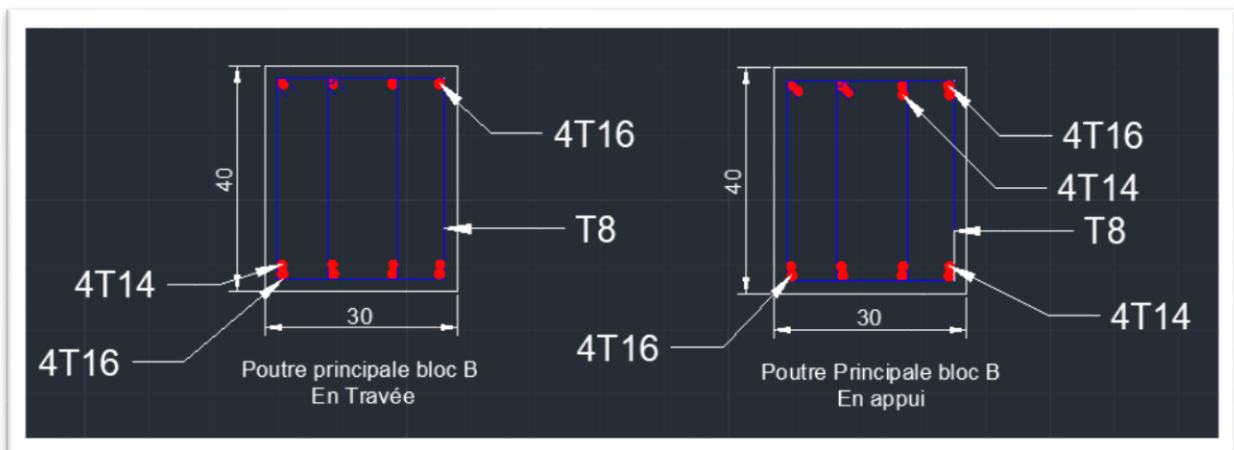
Schéma du ferrailage de la poutre principale du bloc B
